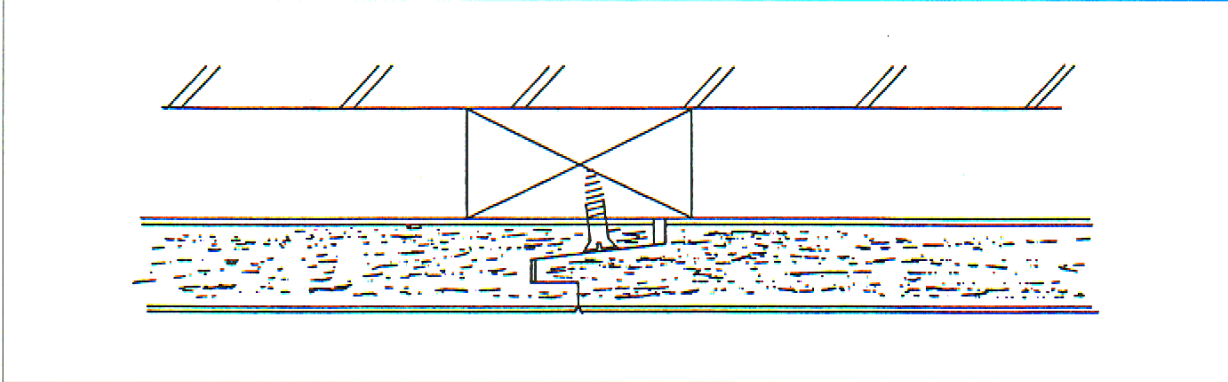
Verschrauben durch eine entsprechende profilierte Elementkante auf Unterkonstruktion
